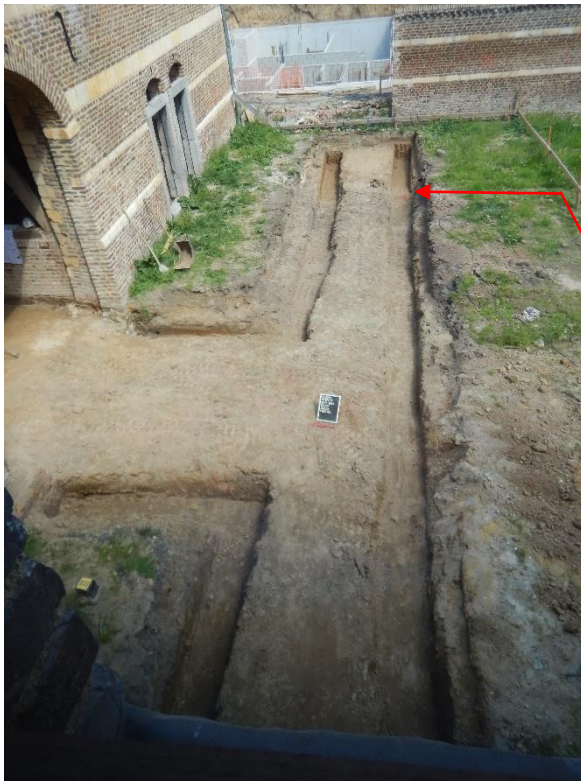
Algemeen zicht op de uitgraving op de binnenkoer voor de bouw van de corridor met aanduiding van het muurfragment.
